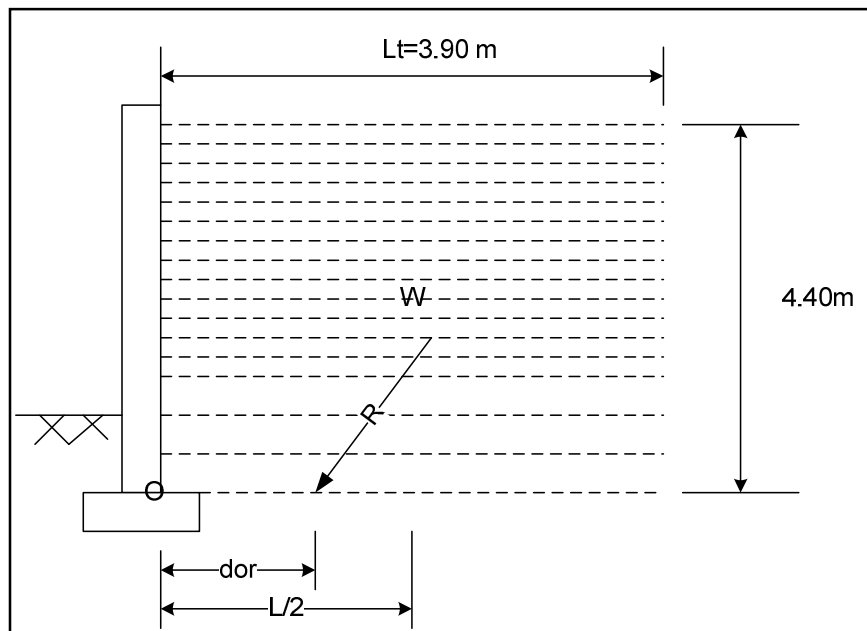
Fuerzas estabilizadoras finales muro 4 m
